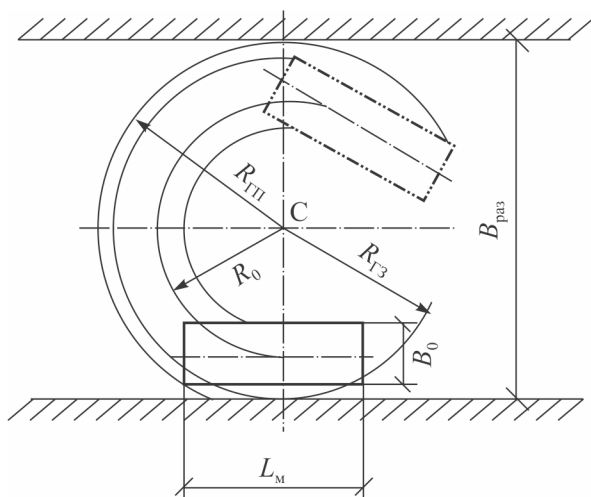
Расчетная схема определения ширины площадки, предназначенной для разворота автомашин на 180°
